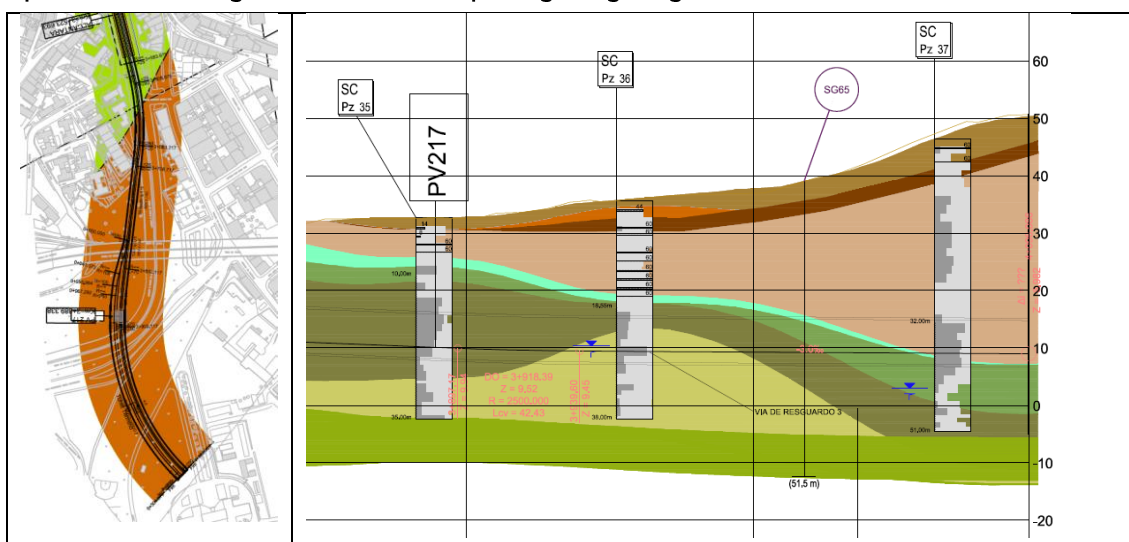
Planta e perfil longitudinal – Geologia / Geotecnia
